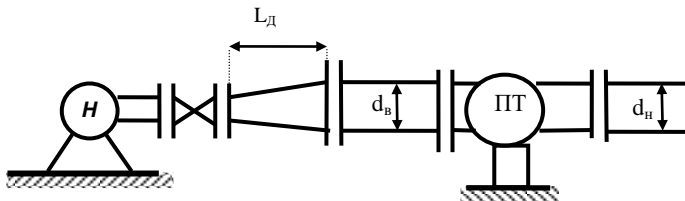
Схема внутростанционного напорного трубопровода с переключающим трубопроводом (ПТ)
